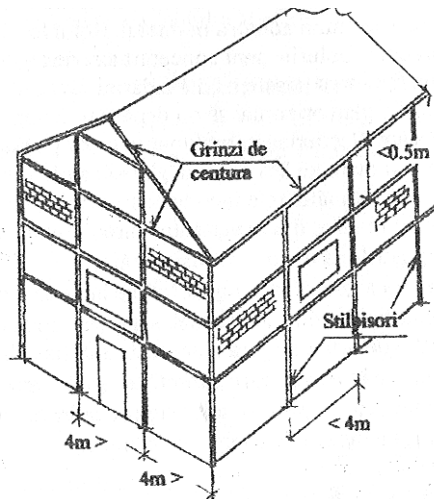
Realizarea elementelor de beton armat la pereții de închidere
